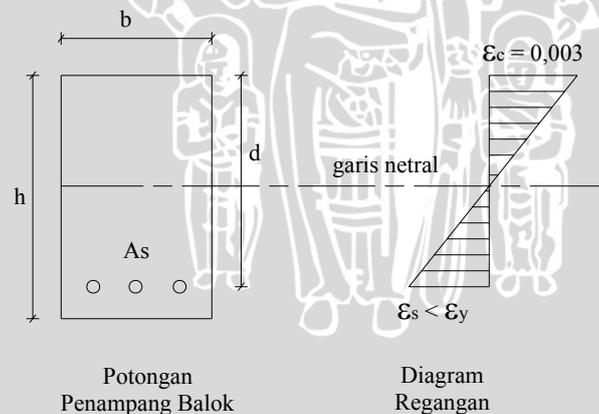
Penampang Balok dengan Penulangan Seimbang
